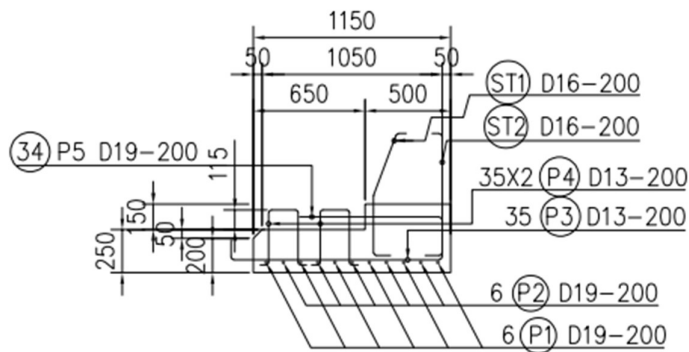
Detail Penulangan *Half Slab* Tebal 25 Cm
